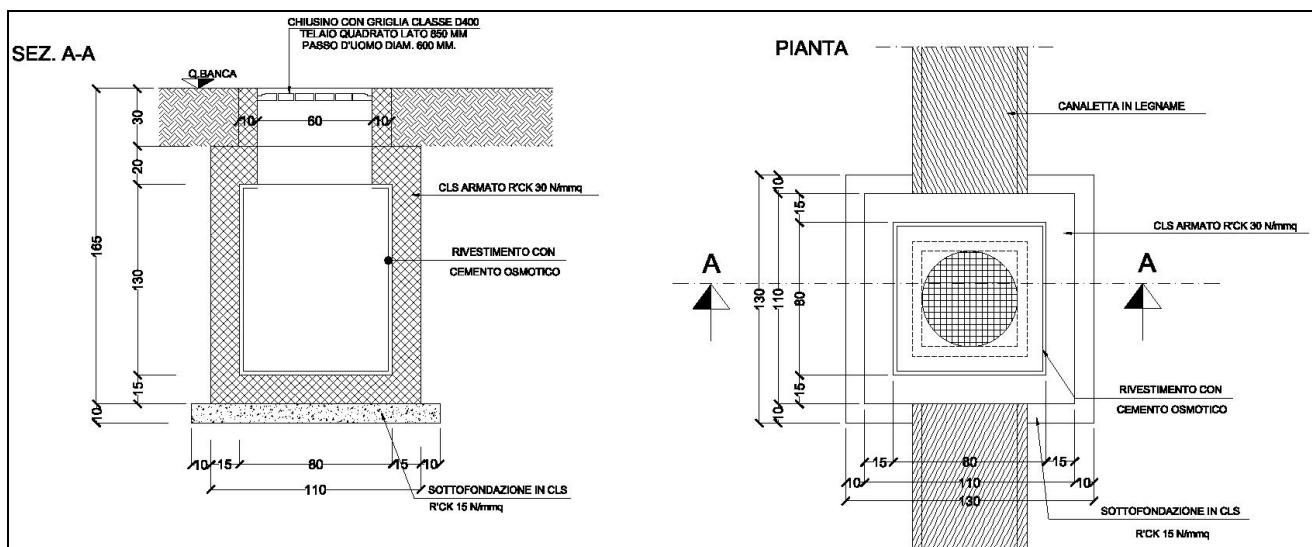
Compluvio centrale – Pozzetto di decantazione in c.a. prefabbricato
